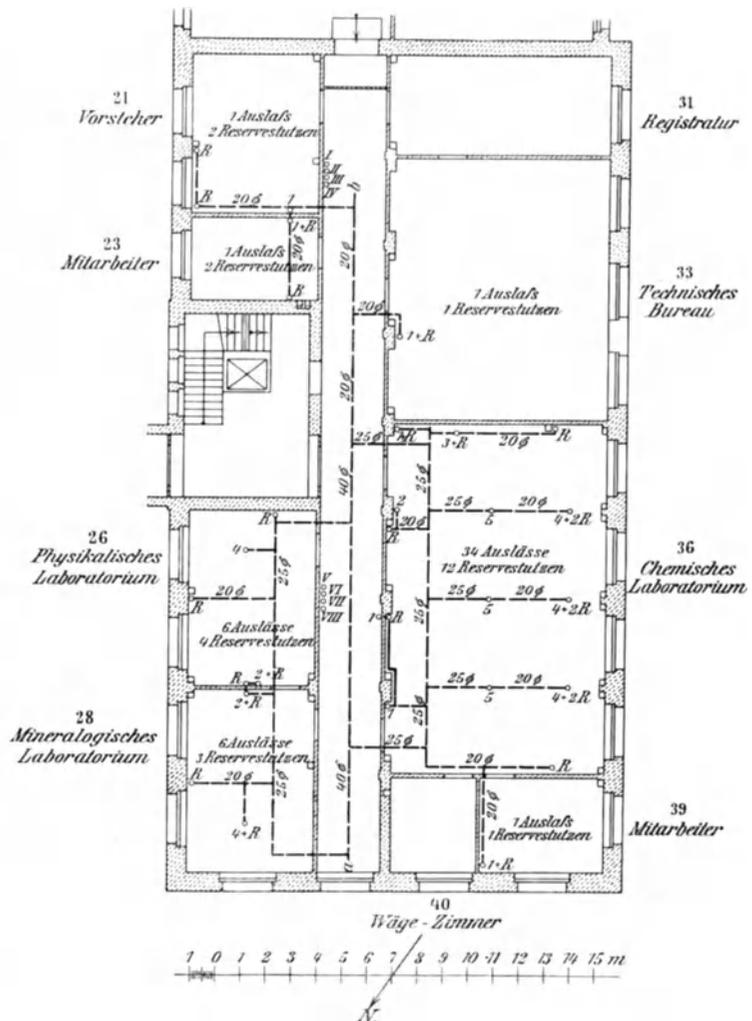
Betriebswasserleitung im Erdgeschoß des westlichen Laborgebäudes mit den Entnahmestellen in diesem Geschoß.
